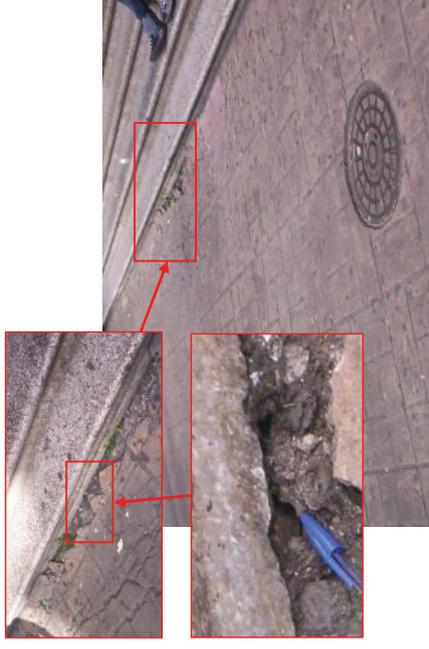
Recalques com fissuras que propiciam a infiltração de água entre o calçamento e escada da fachada frontal do Cine Teatro Central.
